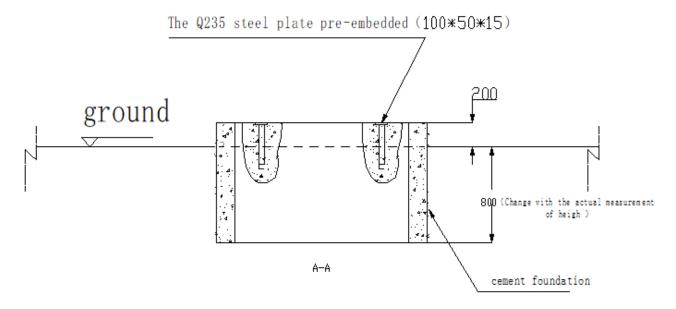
Schematische Darstellung des Betonfundaments
